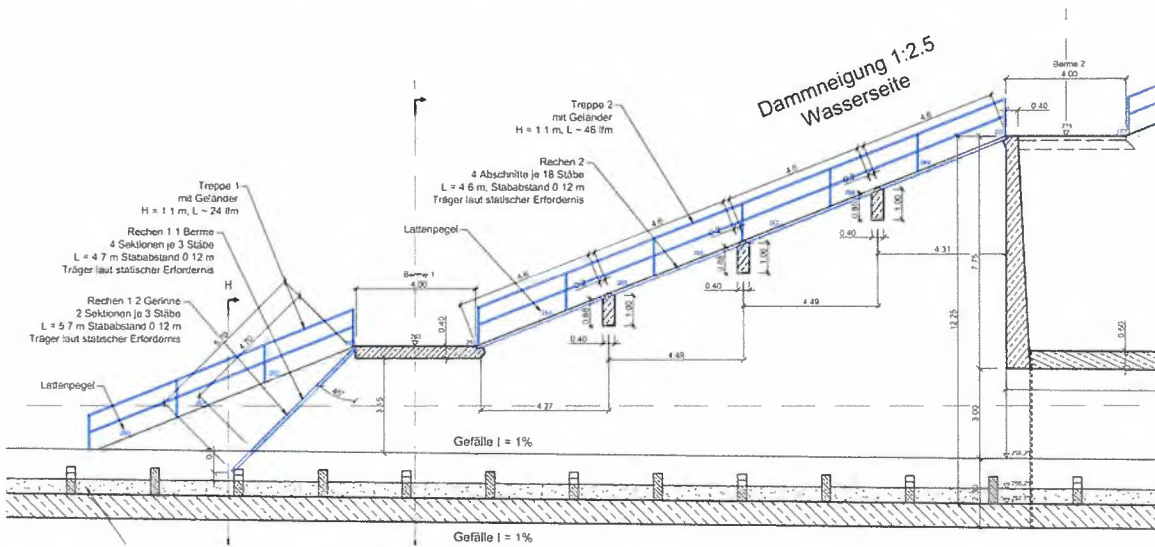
Längsschnitt durch das Rechenbauwerk des Grundablasses (aus Beilage 12.5.4)
